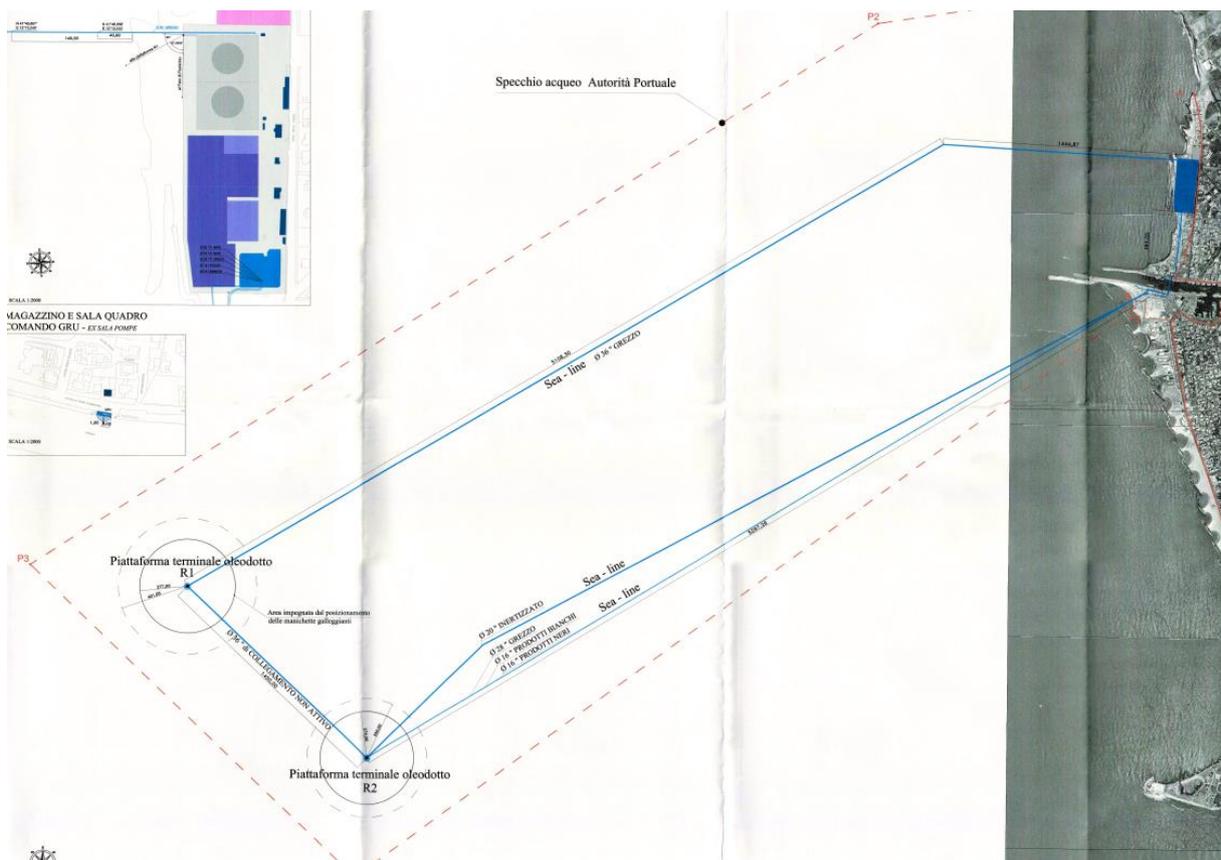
Planimetria schematica della posizione delle tubature (IP Industrial)
